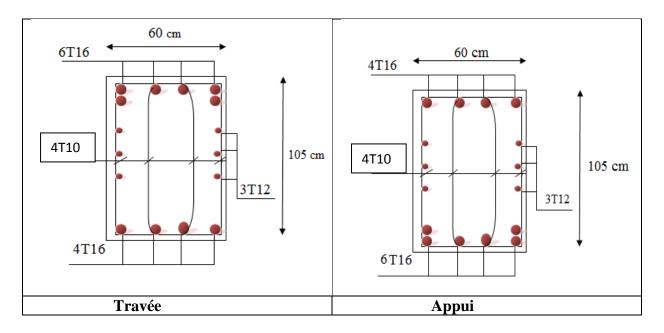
Ferraillage des nervures pour sens longitudinale.
